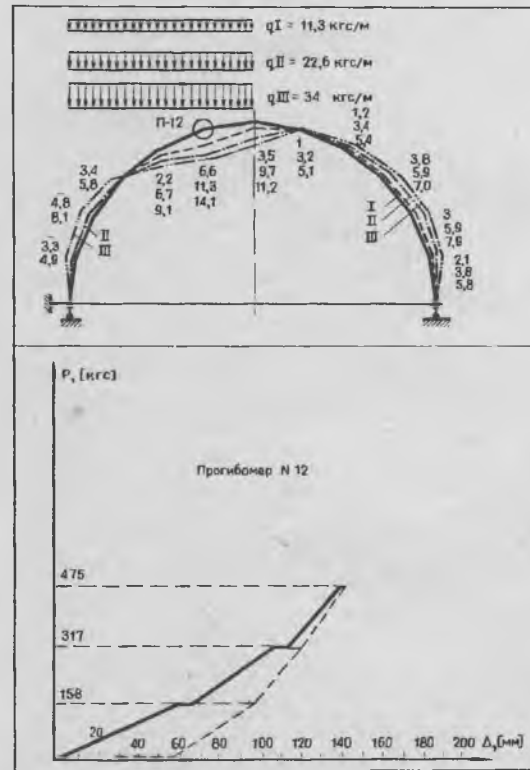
Эпюры перемещений узловых точек каркаса упругогибкого покрытия при одностороннем нагружении
